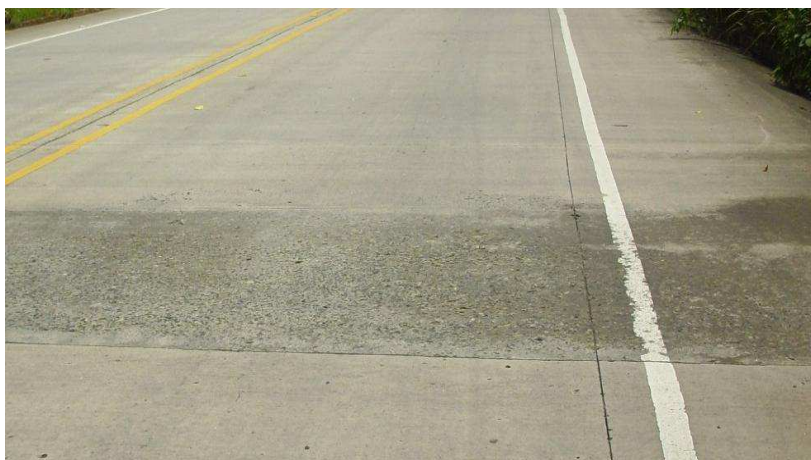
Fisura longitudinal de la vía Pavón-Flavio
